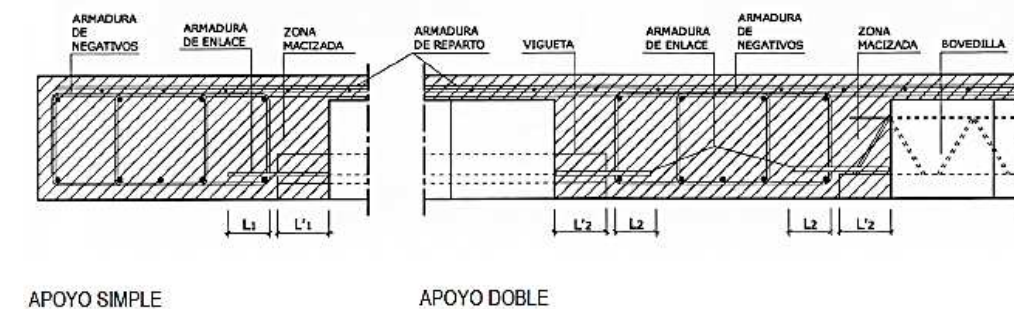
Detalle del apoyo indirecto por solapo de las viguetas con la viga
